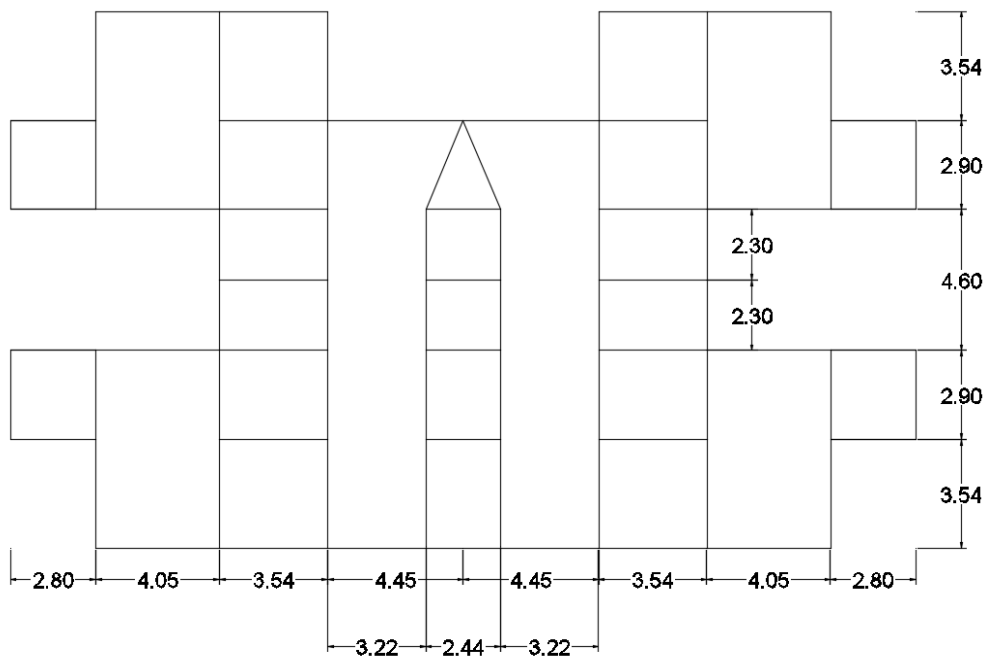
Planta de cimentación en formato digital del bloque 11 de San Fernando (Fuente: Ministerio de la Vivienda, 1973)
